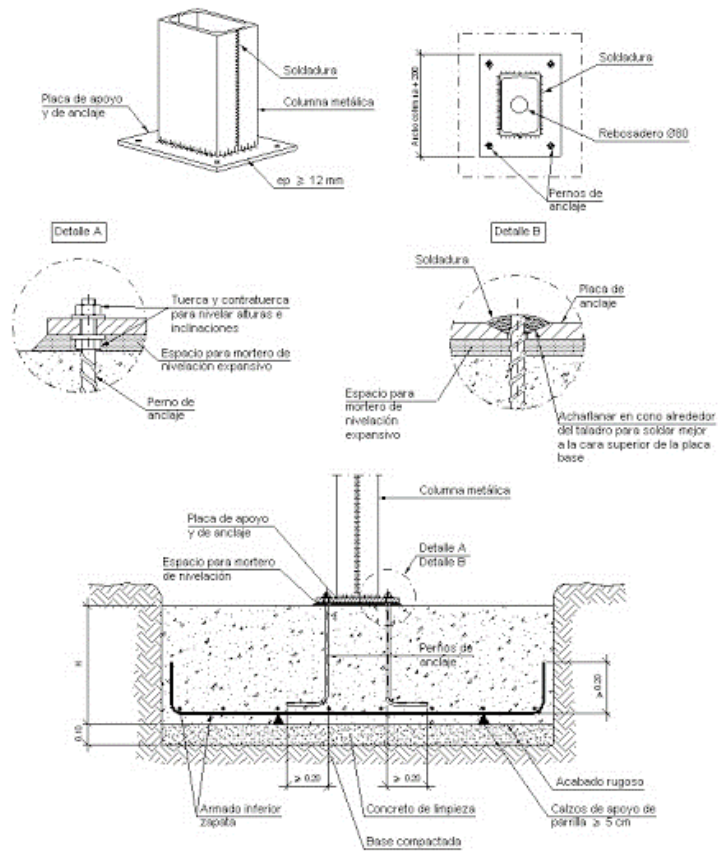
Detalle de soldaduras Columnas 2UPN y Fundaciones (2020)
